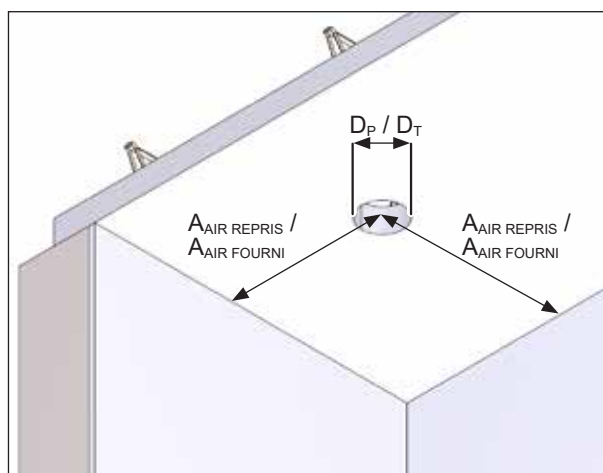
Avant-trou pour caisson de plafond – diamètre minimal et espacement minimal
